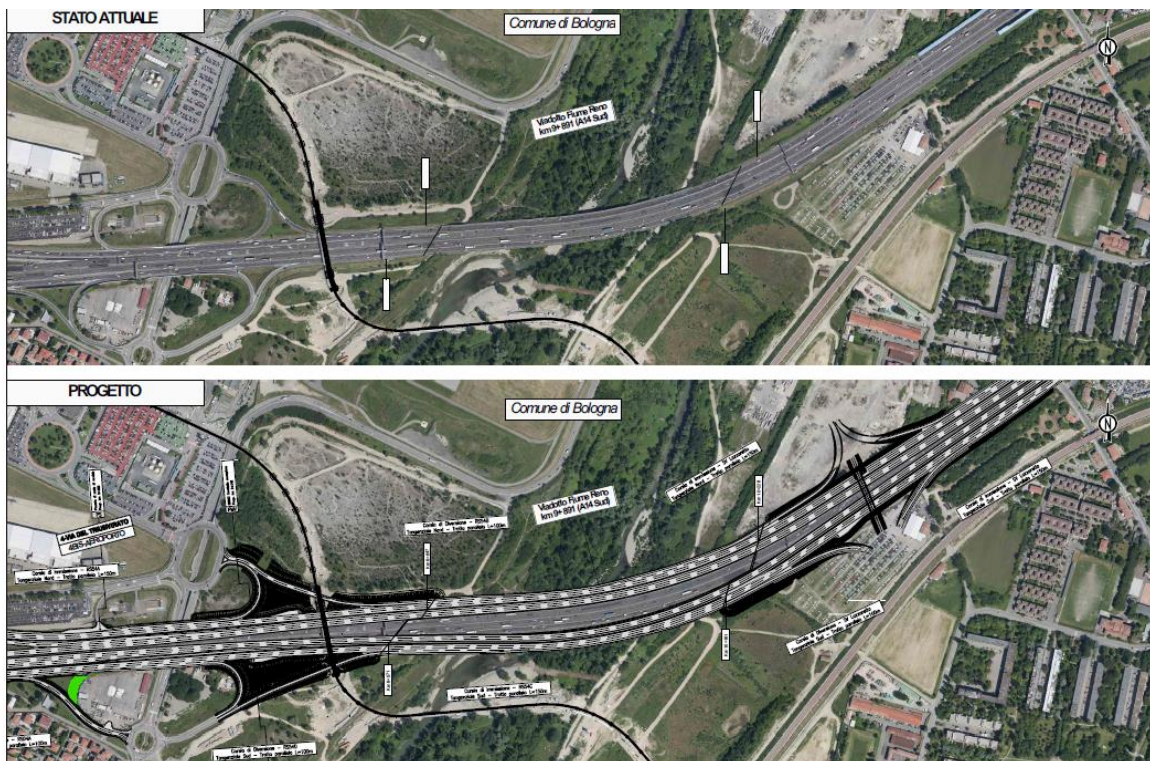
Ortofoto dello stato attuale e del nuovo progetto del viadotto sul fiume Reno
